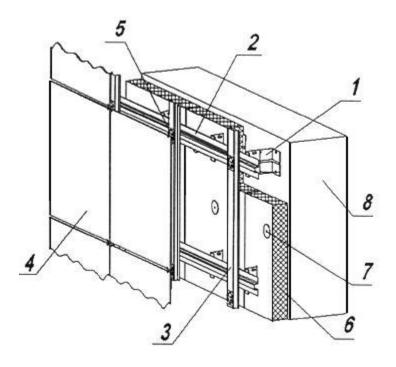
Конструкция НВФС с перекрестной схемой расположения направляющих и облицовкой из плит керамогранита
